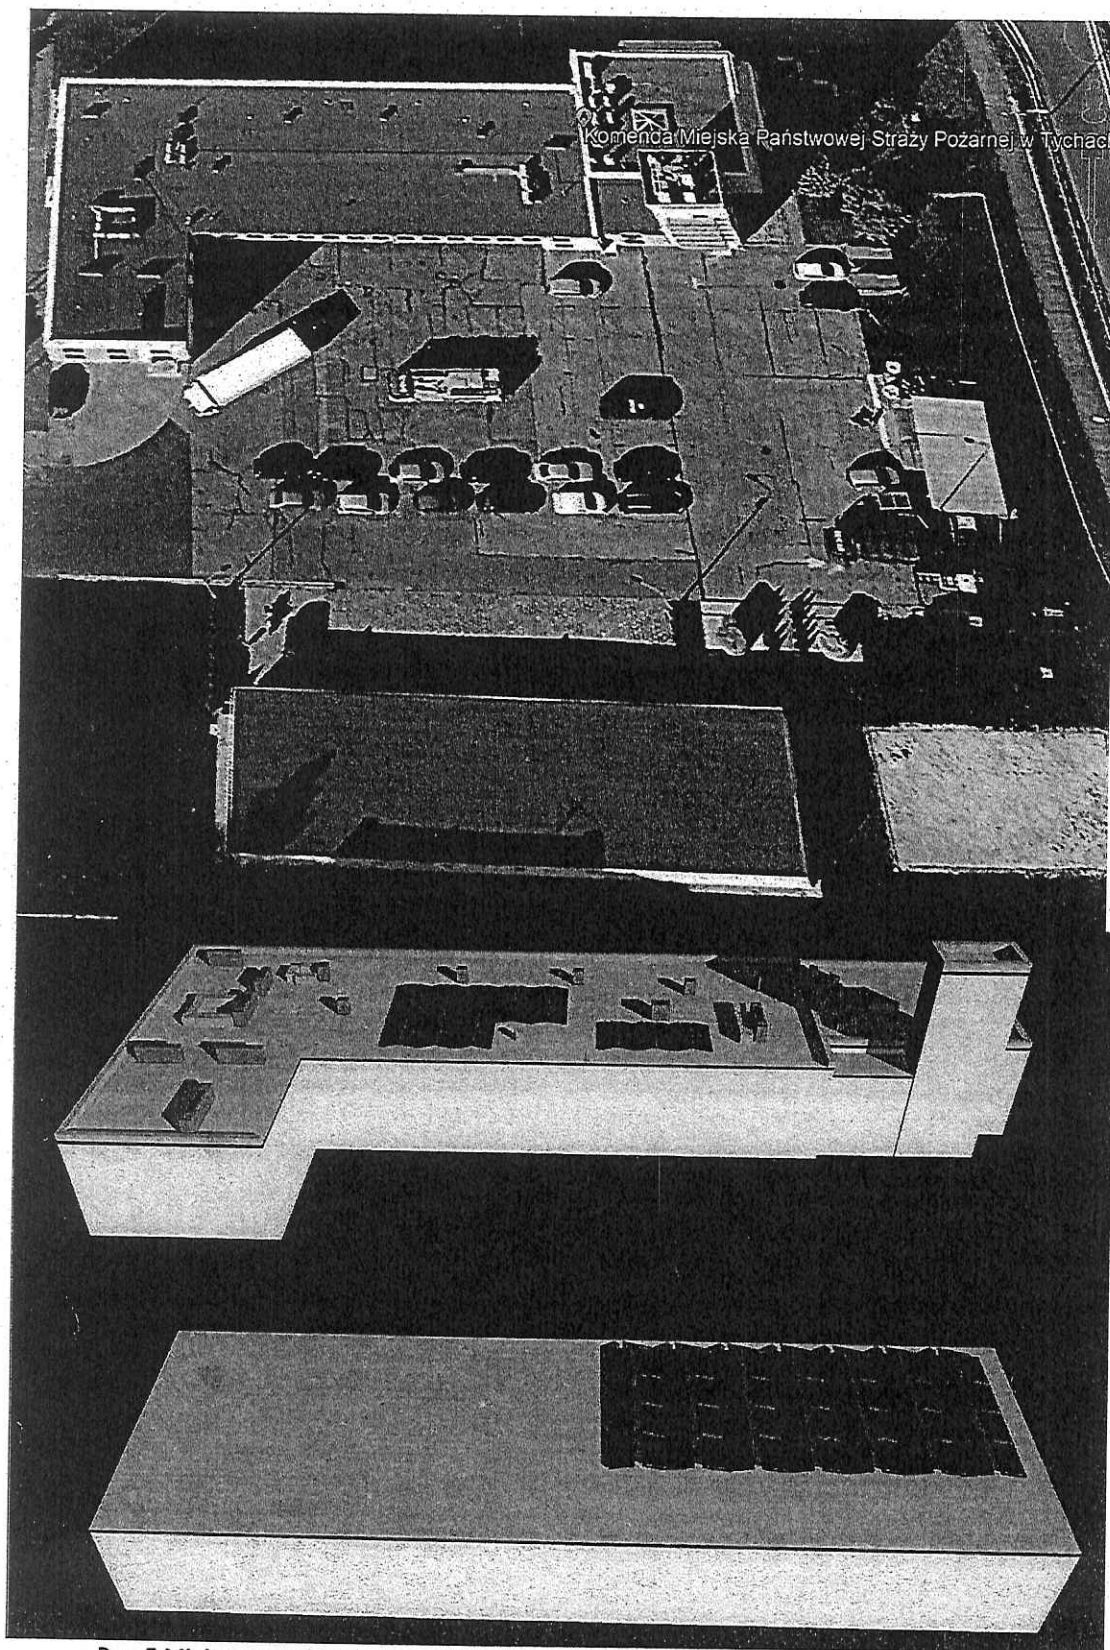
Wizualizacja dachowej instalacji fotowoltaicznej na dachu budynku warsztatowo-garażowego KM PSP w Tychach
